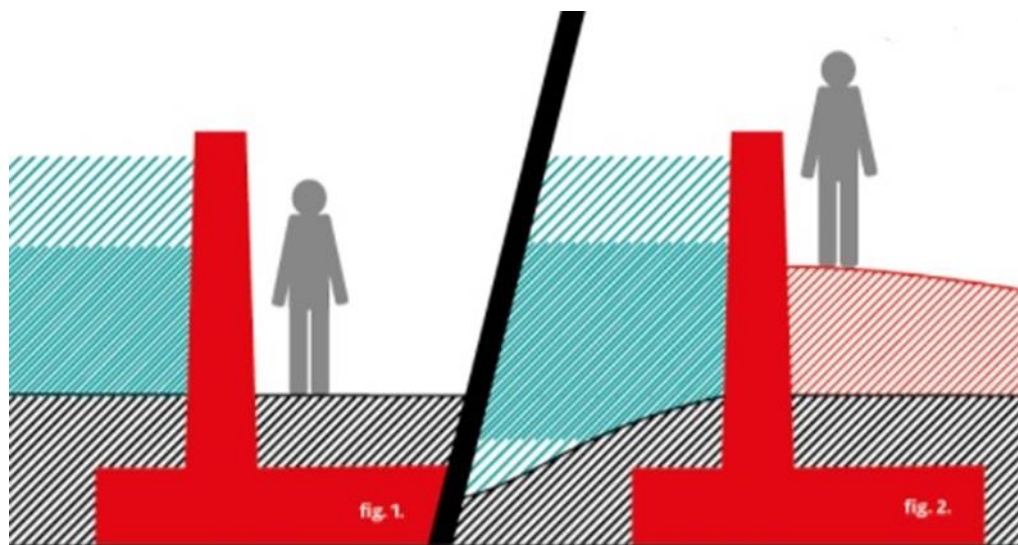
III. etapa dva možné přístupy železobetonových zdí
